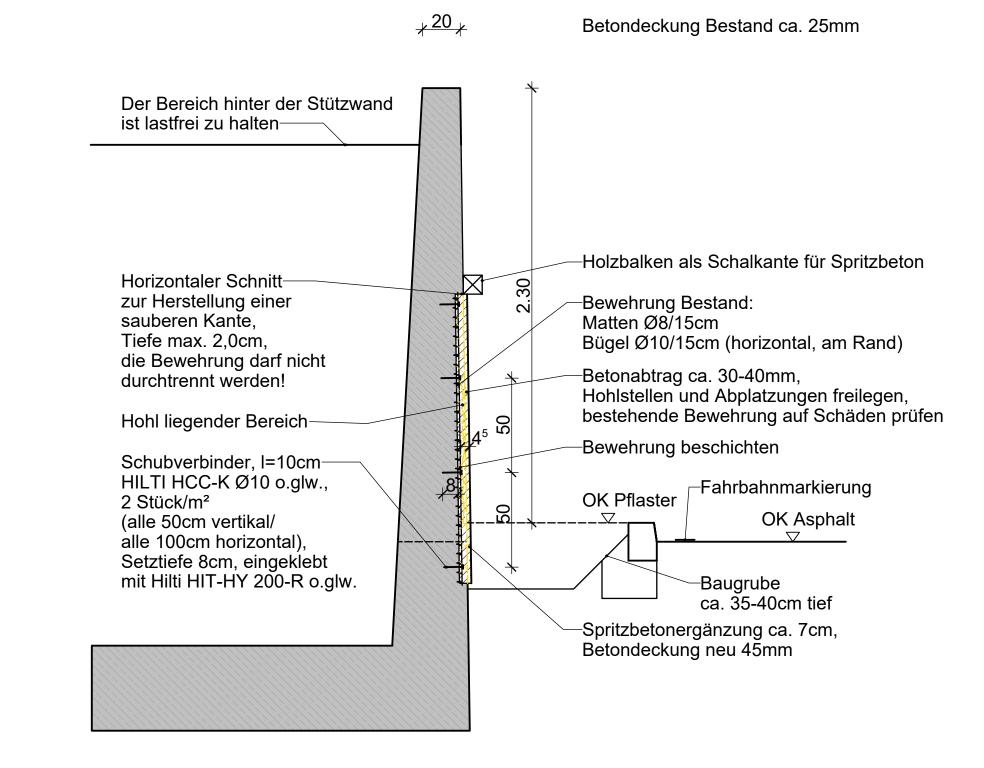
Segment 1 Instandsetzung, M 1:5
